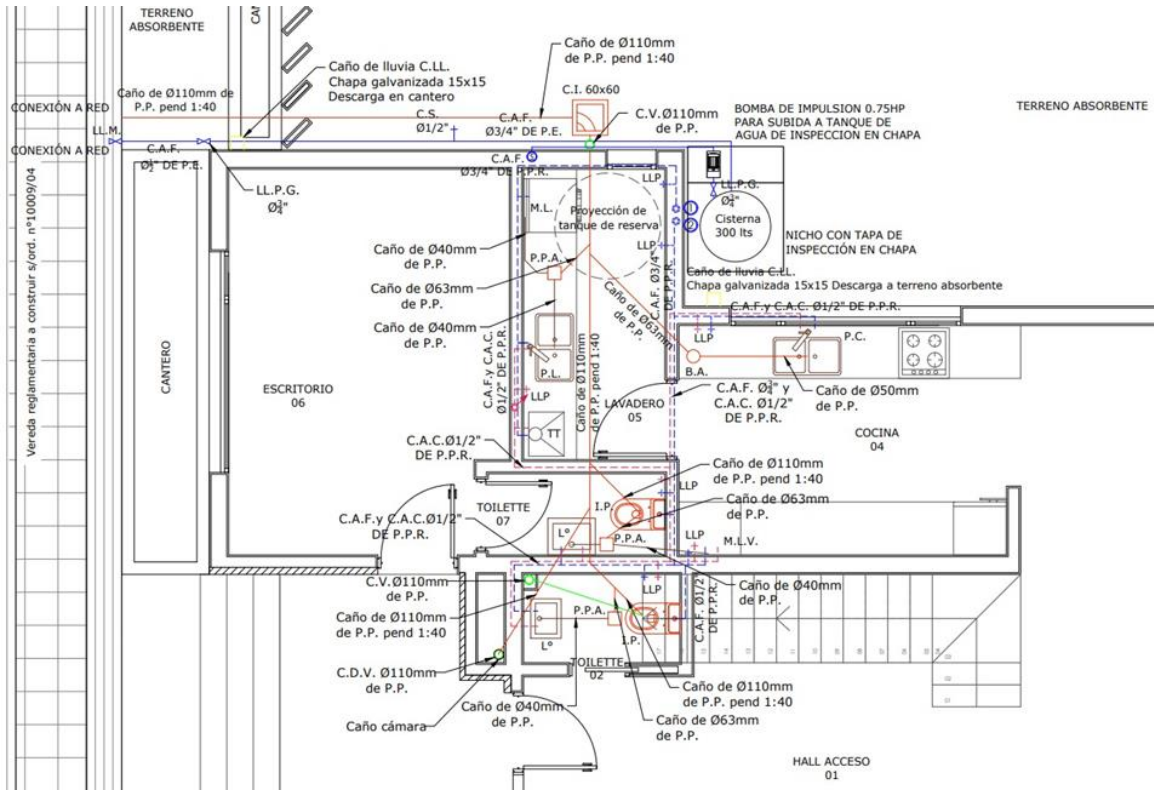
Ubicación de artefactos y dispositivos en planta baja
